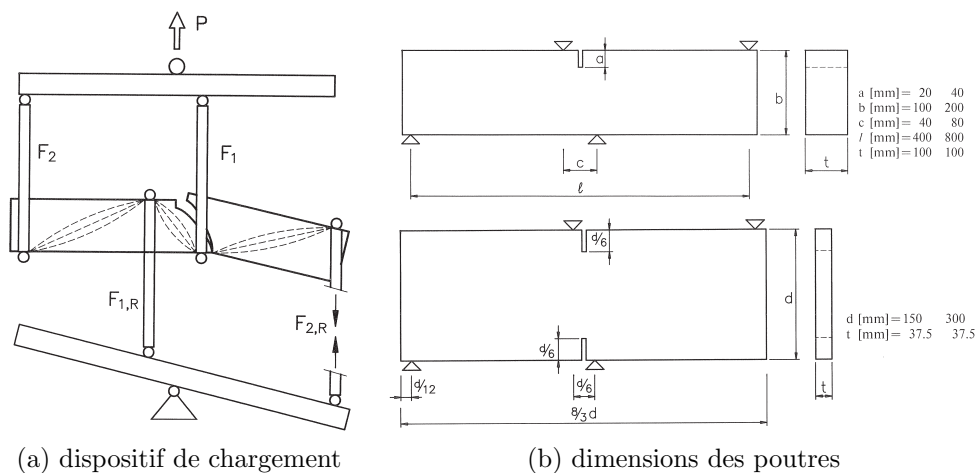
Dispositif des essais des poutres de Schlangen.
